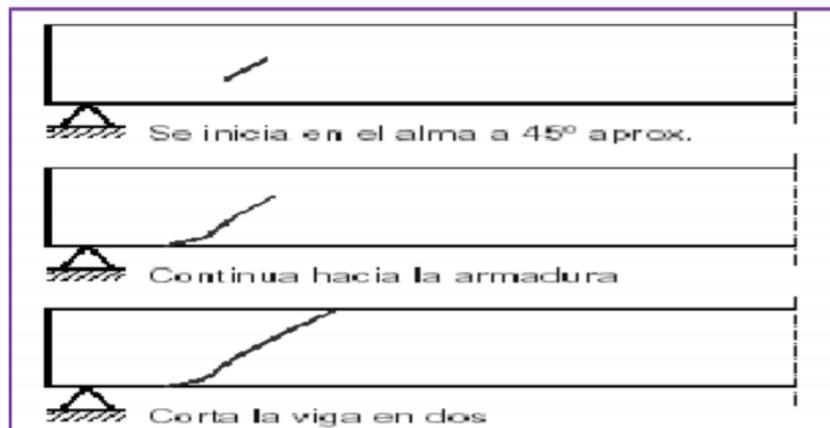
FISURA POR ESFUERZO CORTANTE
